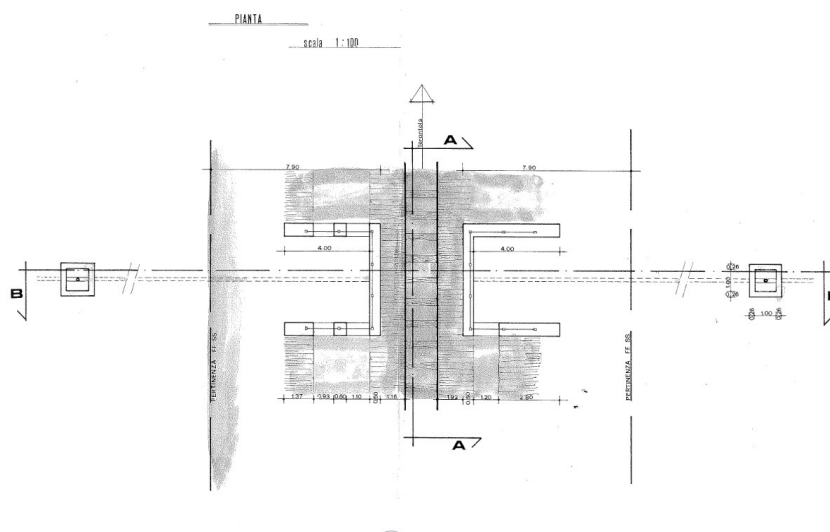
planimetria sifone esistente – rif. convenzione 550251
